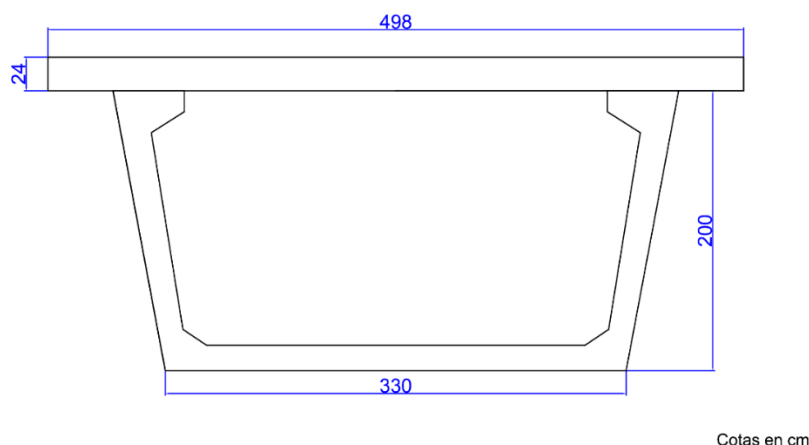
Sección homogeneizada de la viga + losa de compresión
